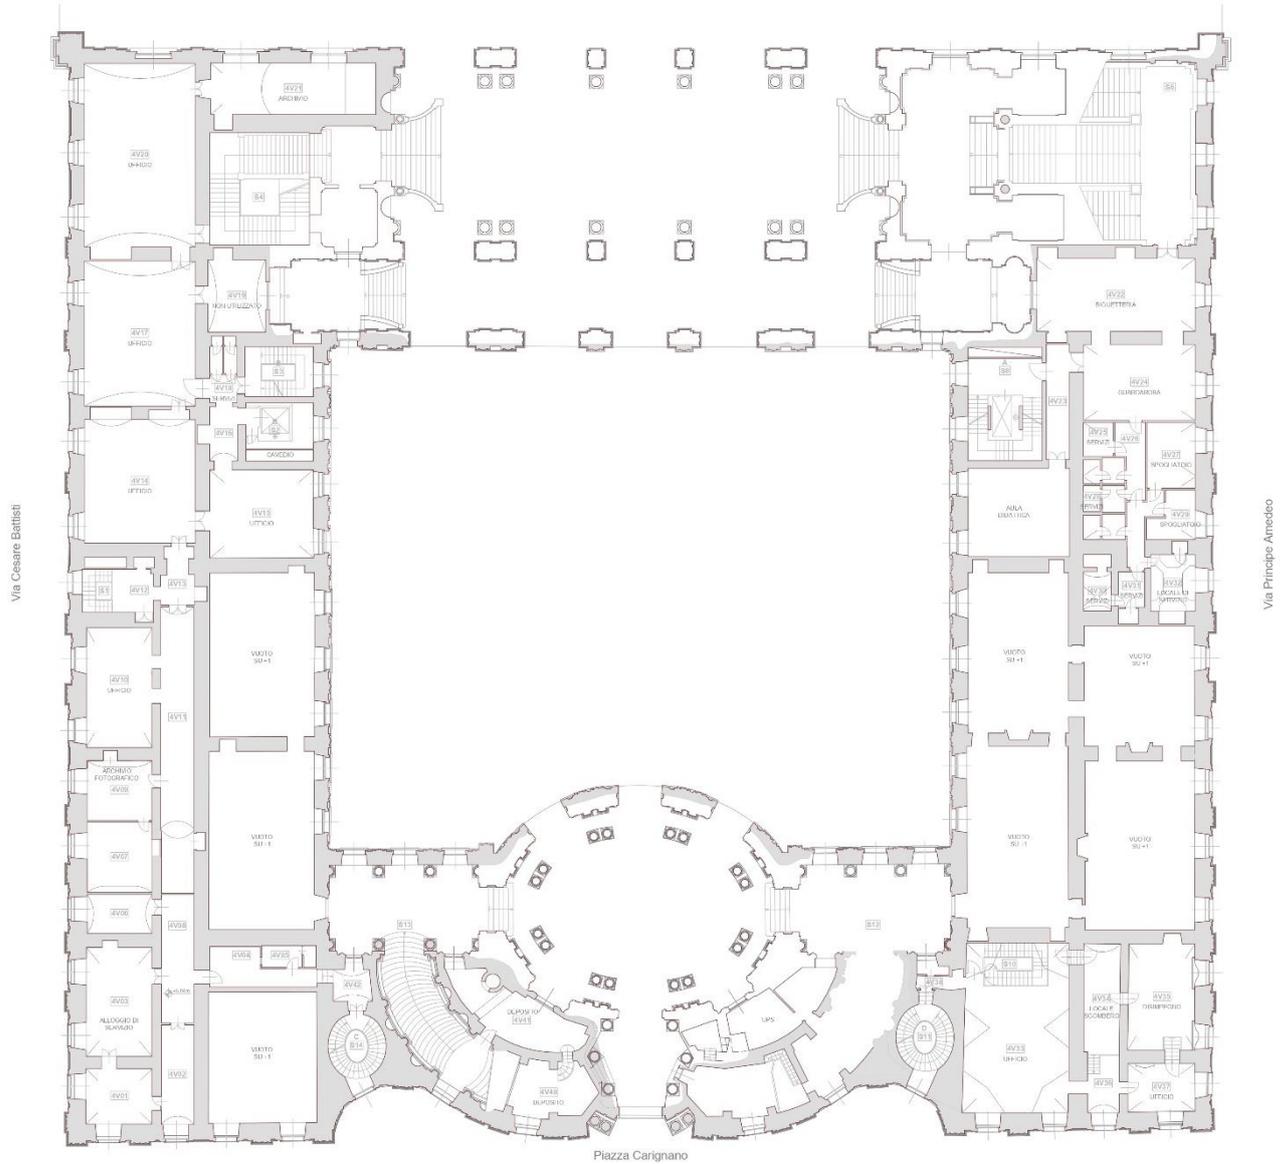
Pianta piano secondo-ammezzato, livello +2 (Fuori scala).
